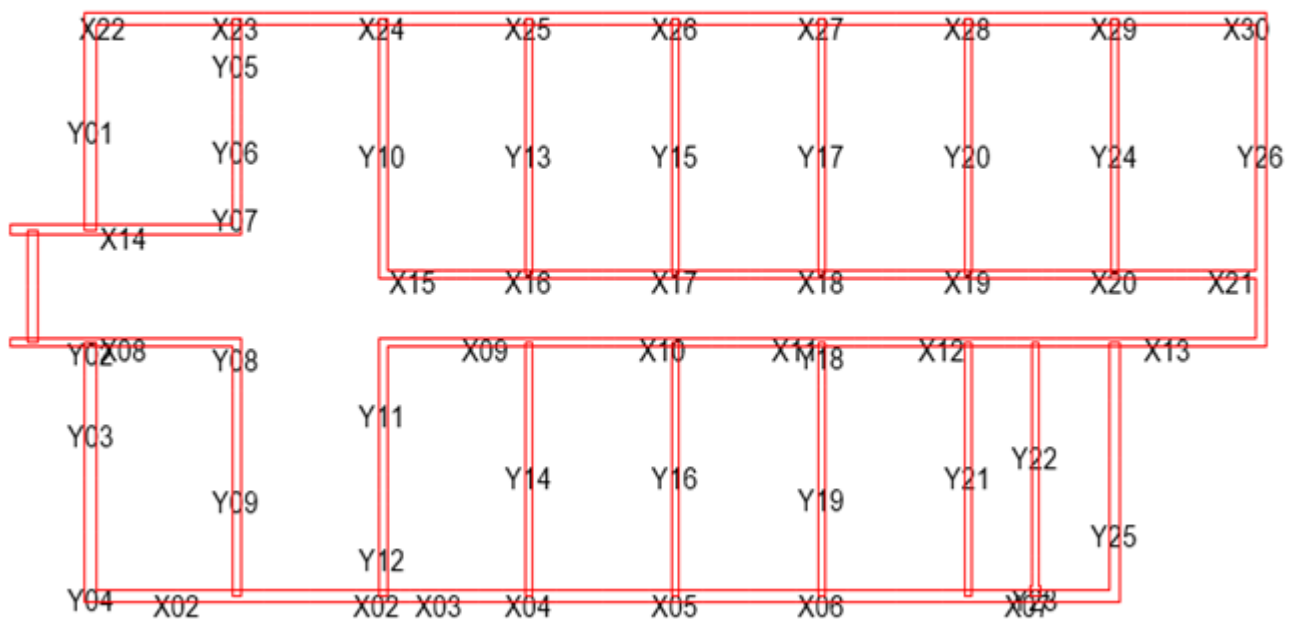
Dispunere in plan spaletii din zidarie (parter)- C1
